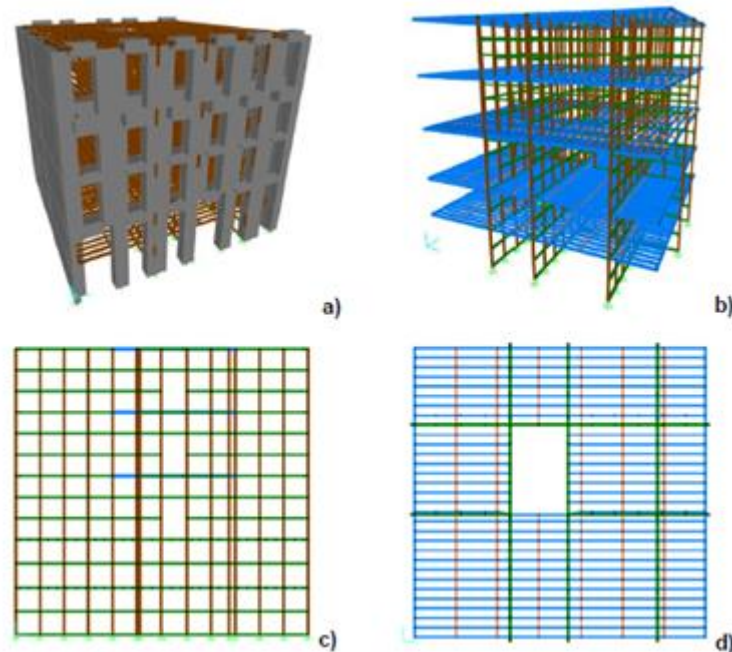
Modelação numérica: a) vista exterior; b) vista interior; c) parede frontal; d) pavimento de madeira 1º andar
